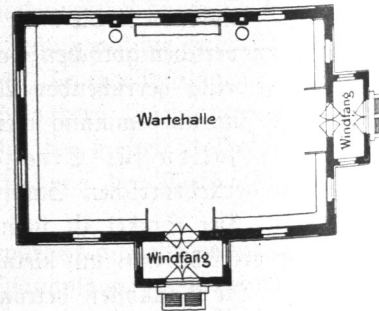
Wartehalle Rübenkamp, Grundriß.
